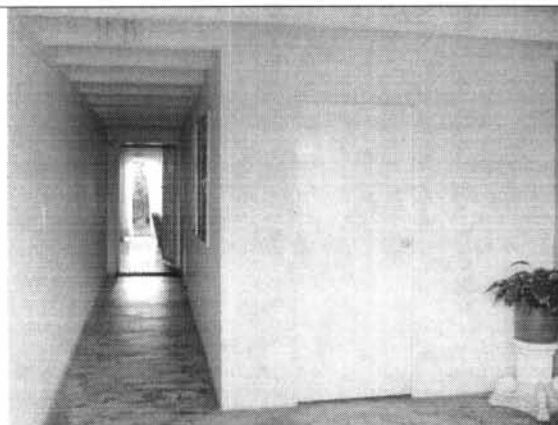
Vista interna de los muros del hall, no se detectó daño alguno.
